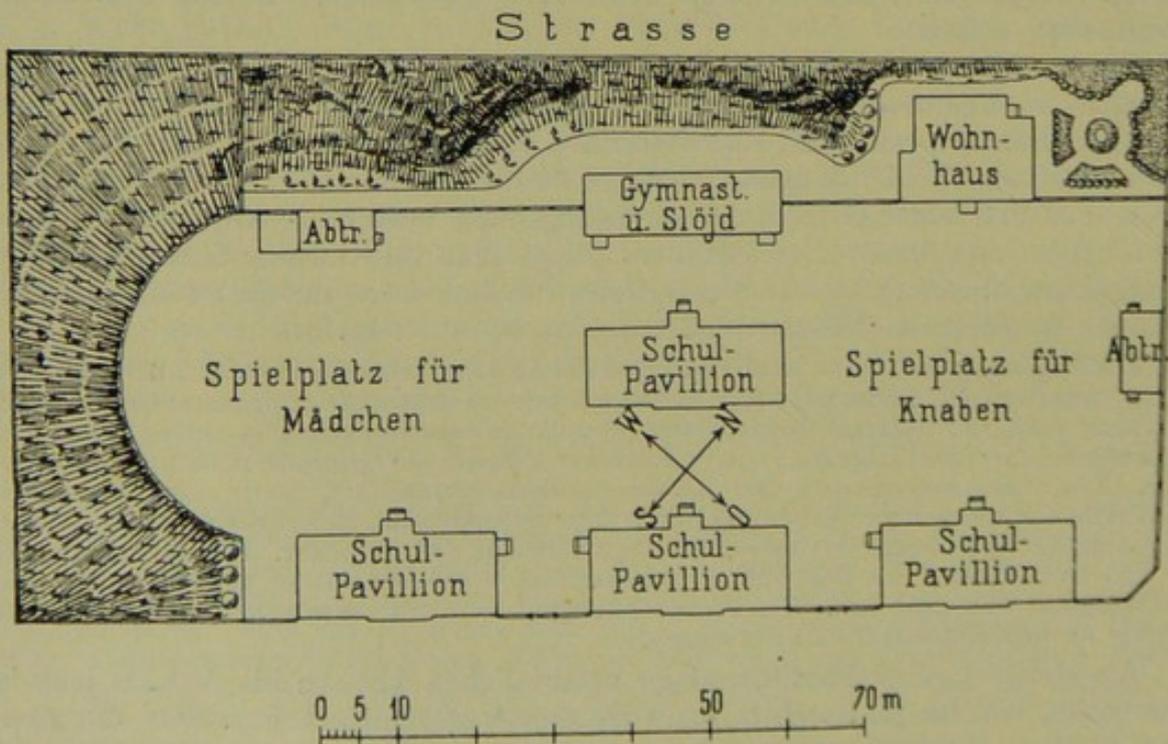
Lageplan der Pavillonanlage in Drontheim.
